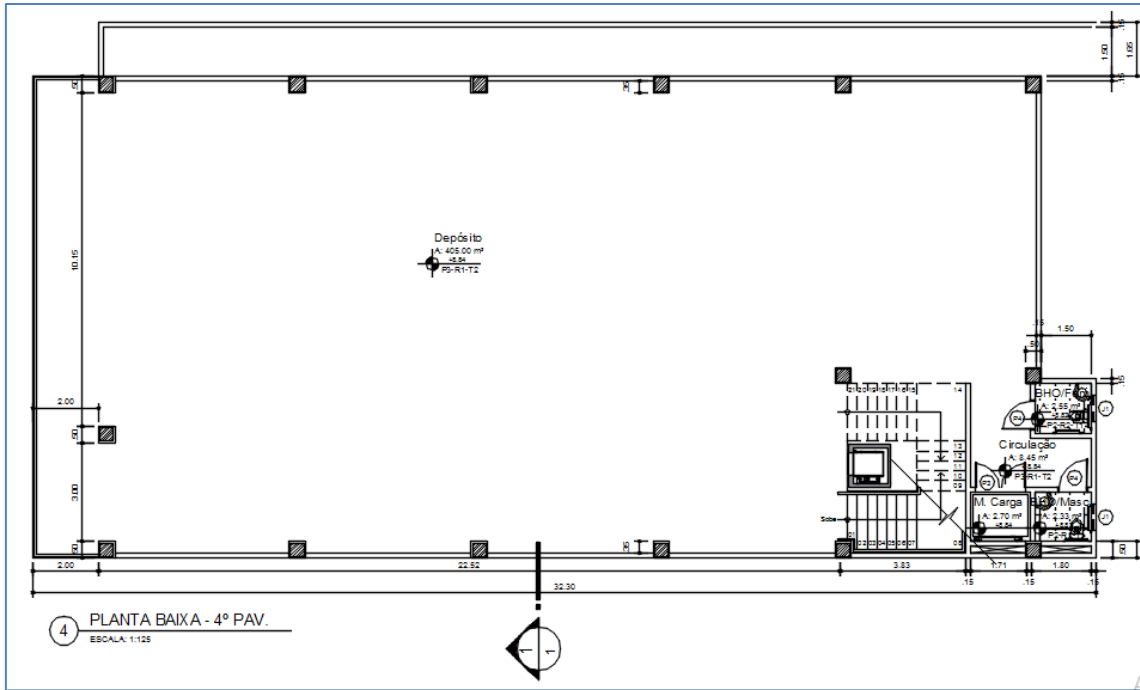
Planta baixa: 4º pavimento (autor do projeto arquitetônico)
